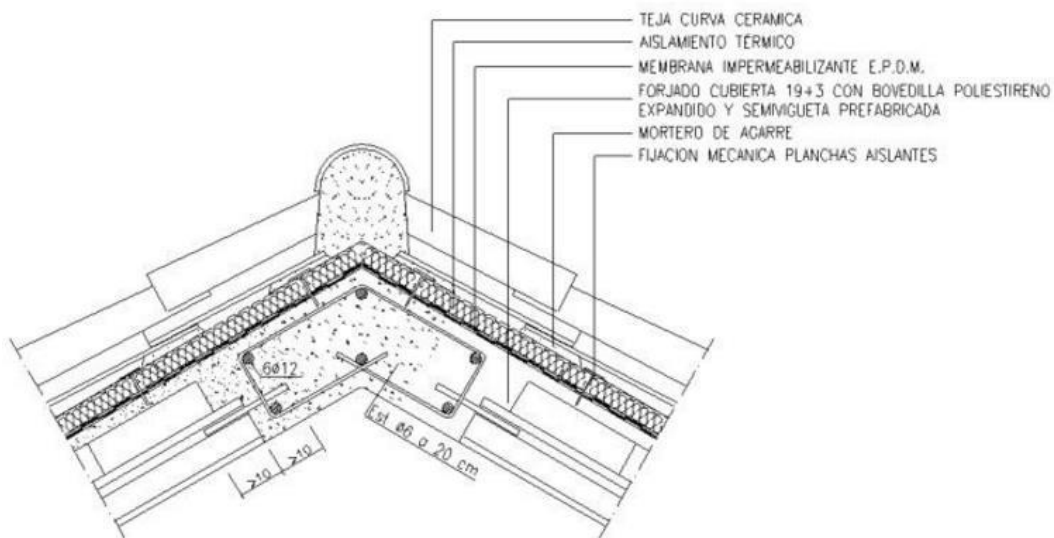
3. Sección tipo de la cubierta de las edificaciones.
